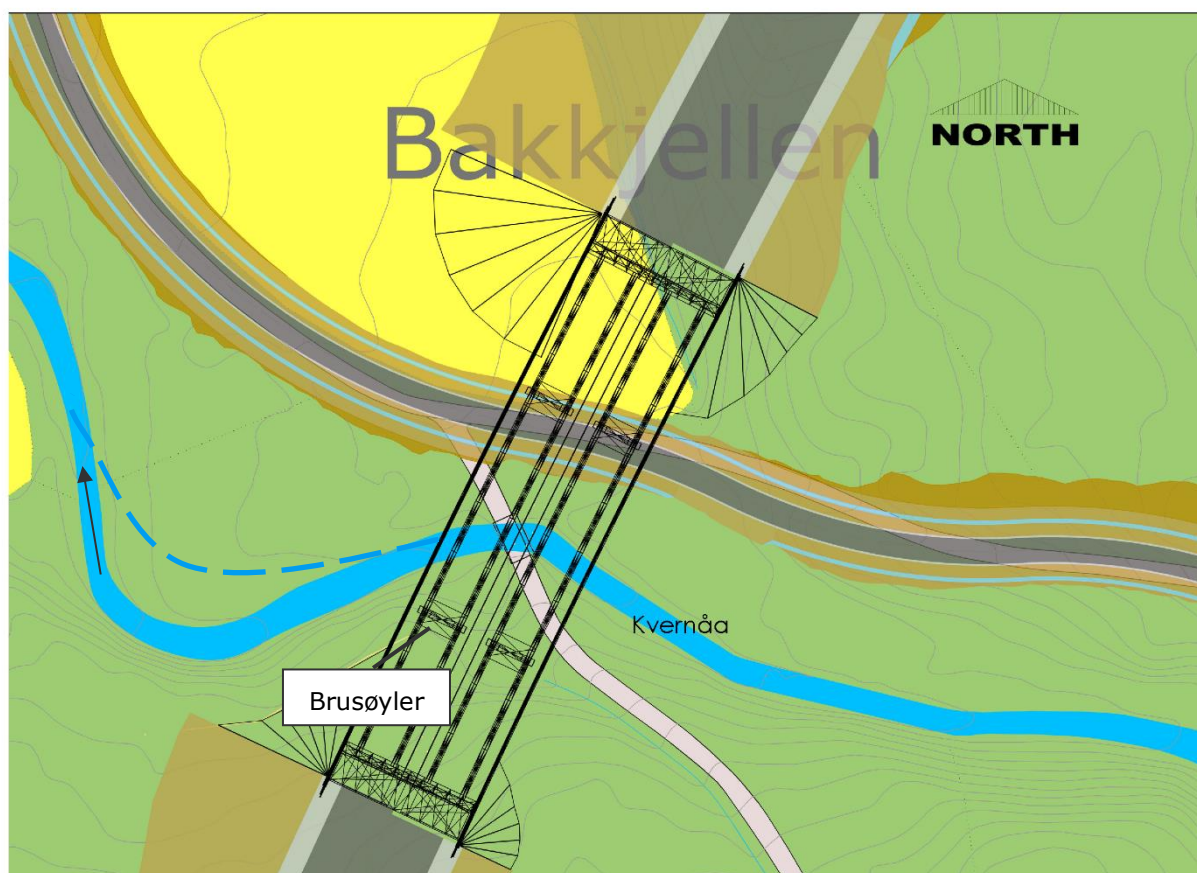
Skisse som viser omlegging av Krokbecken. Det vil legges inn mindre svinger og strømreducerende strukturer i det utrettete løpet under brua, samt større svinger opp- og nedstrøms brua. Svingene vil erosjonssikres med stein. Kilde: Rambøll.
